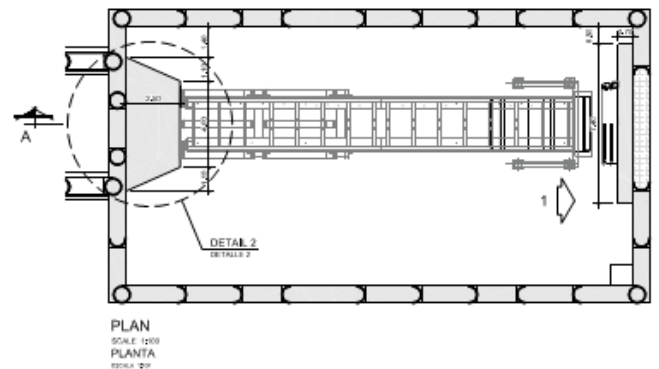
Planta pozo de ataque con muro de reacción y bastidor de empuje doble
